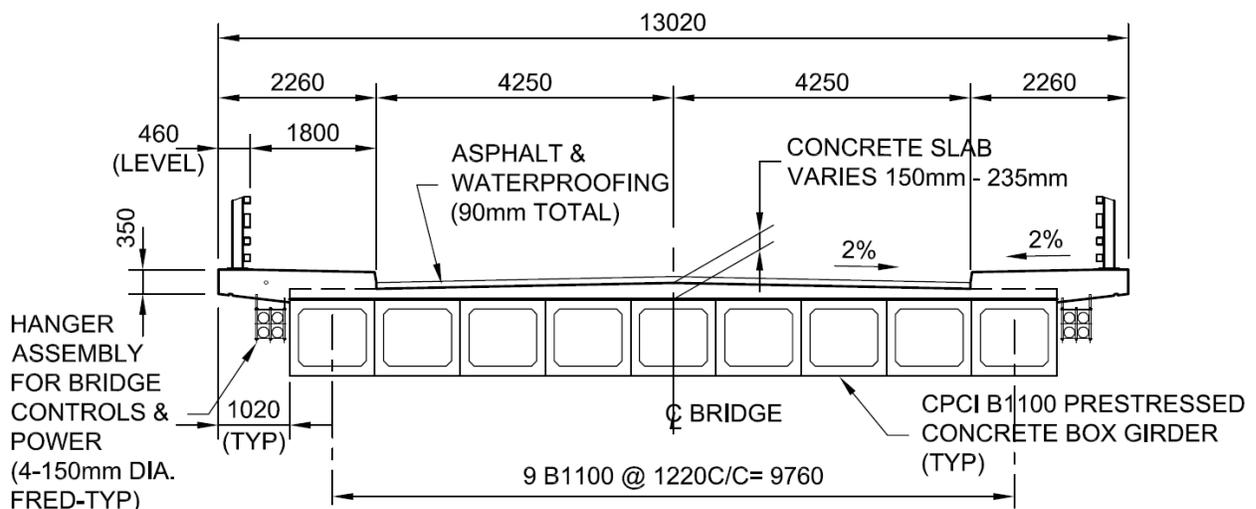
Option d'une travée d'approche avec poutres caissons préfabriquées placées côte à côte
